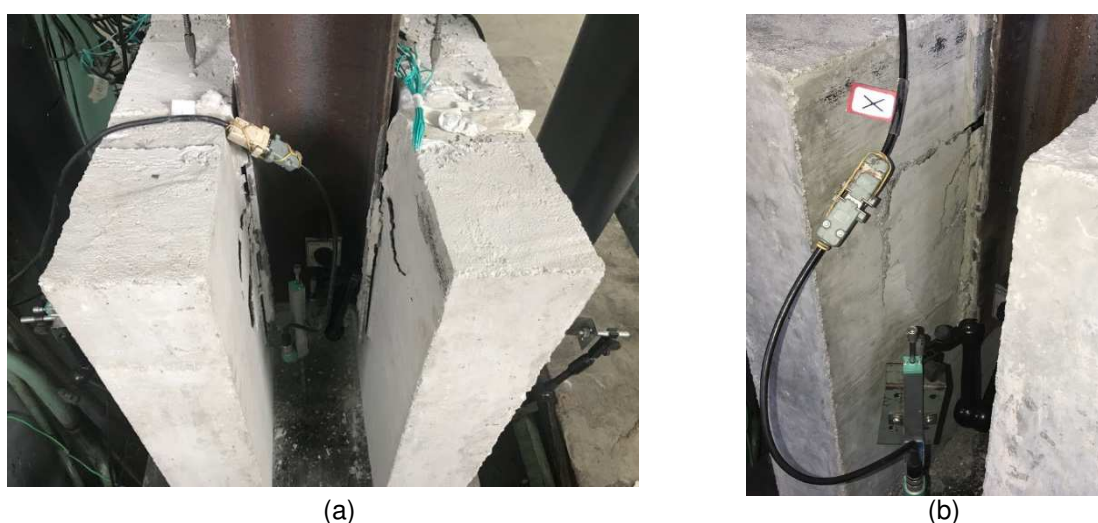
Ruptura da laje de concreto - ensaios TP45
